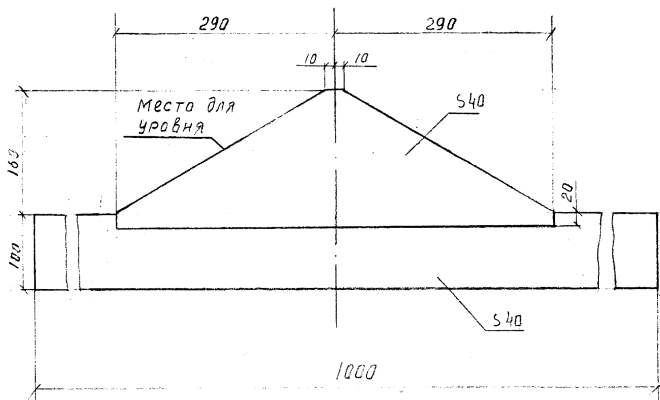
Шаблон деревянный для проверки уклона дна котлована под анкерную плиту для опоры ПУСБ 110-1
